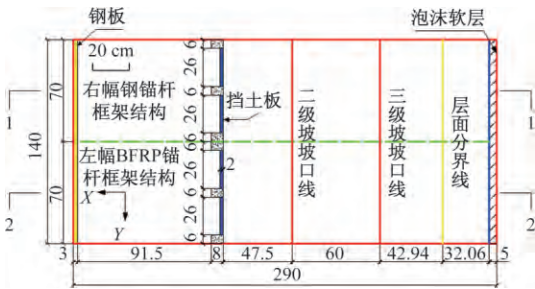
左右两幅边坡中应变片布置示意图(单位: cm)
